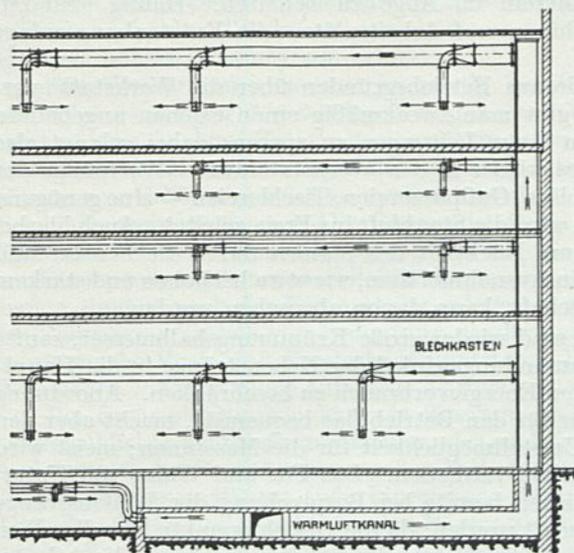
a—c. Werkstattbau mit Überdrucklüftung, zugleich Luftstromheizung, Ausführung der Maschinenfabrik
